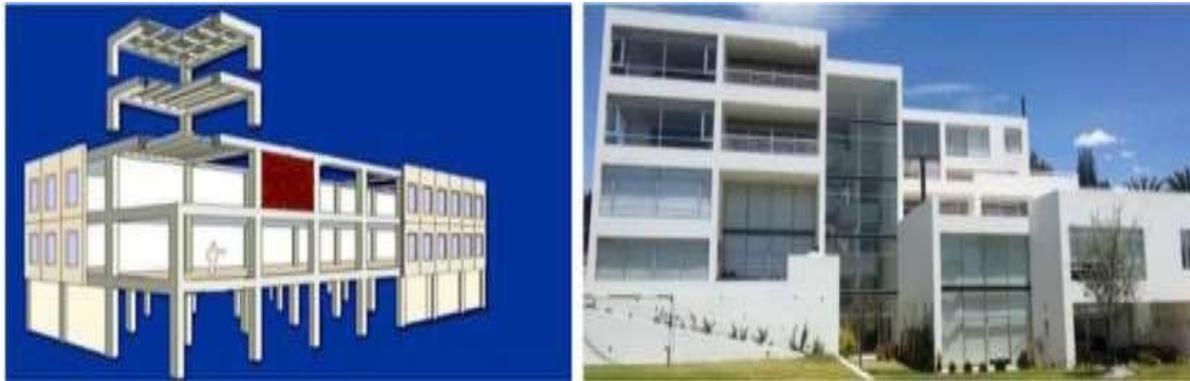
Tipo de sistema estructural: Pórticos de hormigón armado (C1).
